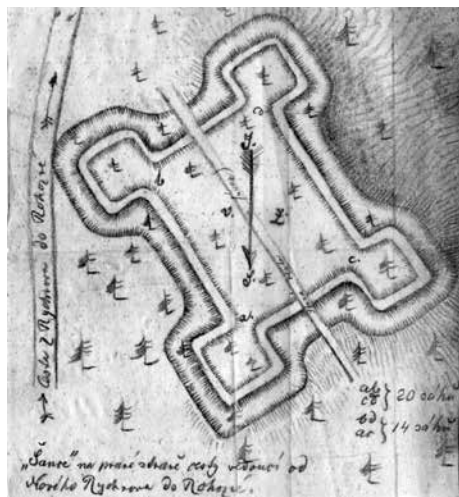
Grundriss der Befestigung. Erstellt von M. Lanta.
